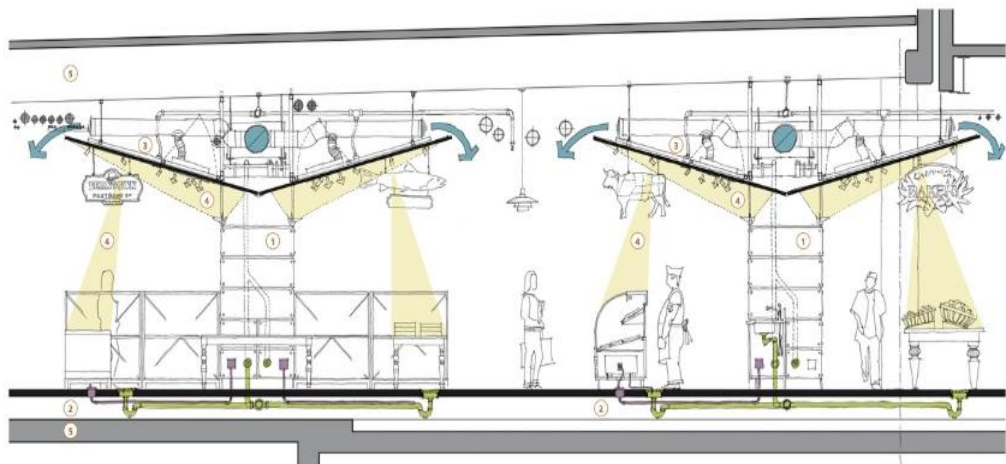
Corte del Mercado Municipal. Fuente: Archdaily (2018).
